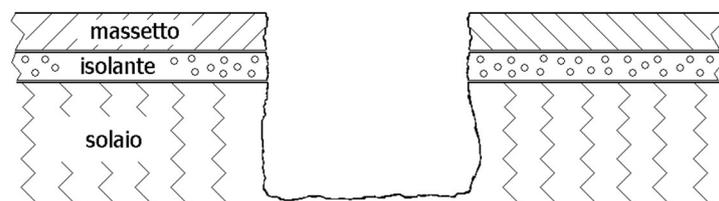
sede di posa del POZZETTO SCARICO LATERALE
